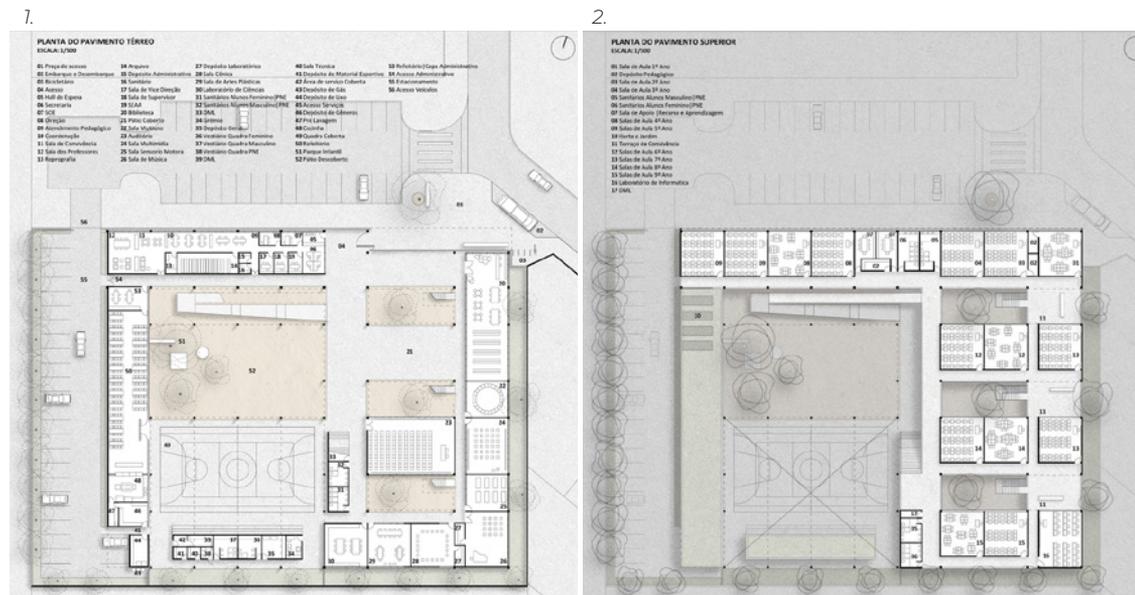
1. Planta Baixa Pavimento Térreo / 2. Planta Baixa Pavimento Superior.
